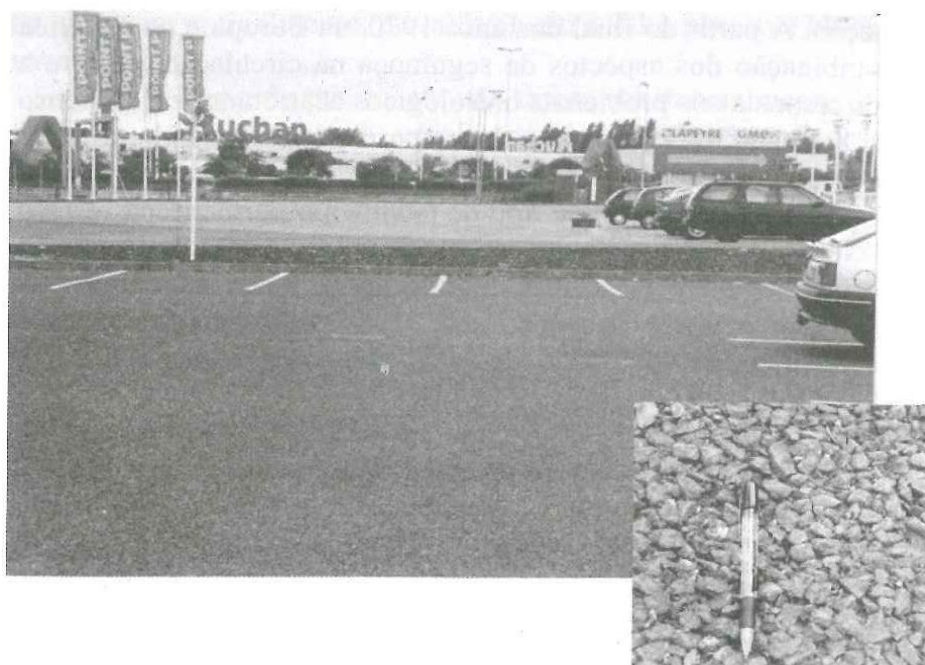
Utilização de pavimento poroso em estacionamento
